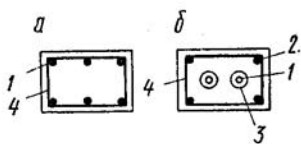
Армирование центрально-растянутых предварительно напряженных стержневых элементов
